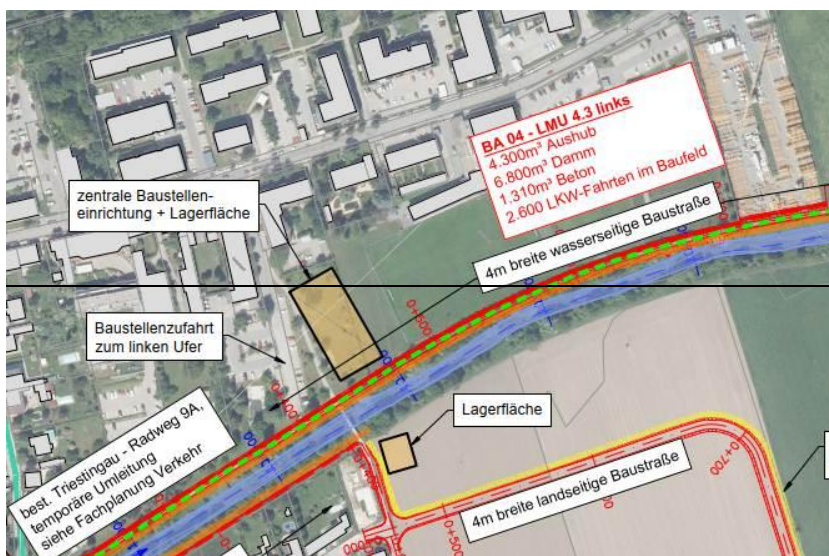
Fitness Outdoorpark, Park am Triestingau Radweg, Sportanlagen ASK Trumau und ASKÖ Trumau, Ausschnitt Übersichtslageplan Baustellenkonzept BA04 Teil 02 (Quelle: Einreichoperat, Einlage 267)
